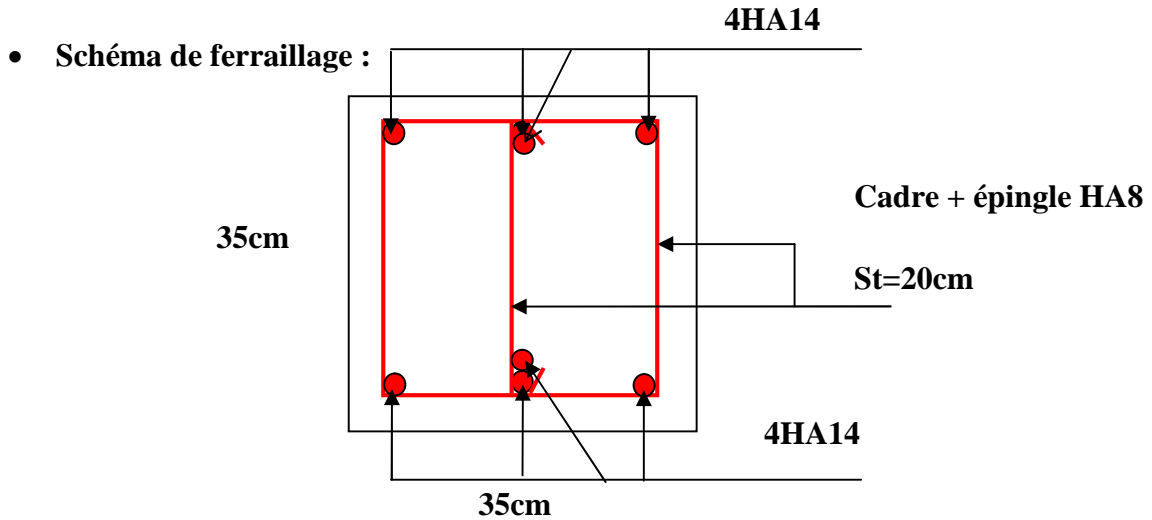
Schéma de ferrailage de la poutre brisée en travée et en appuis
